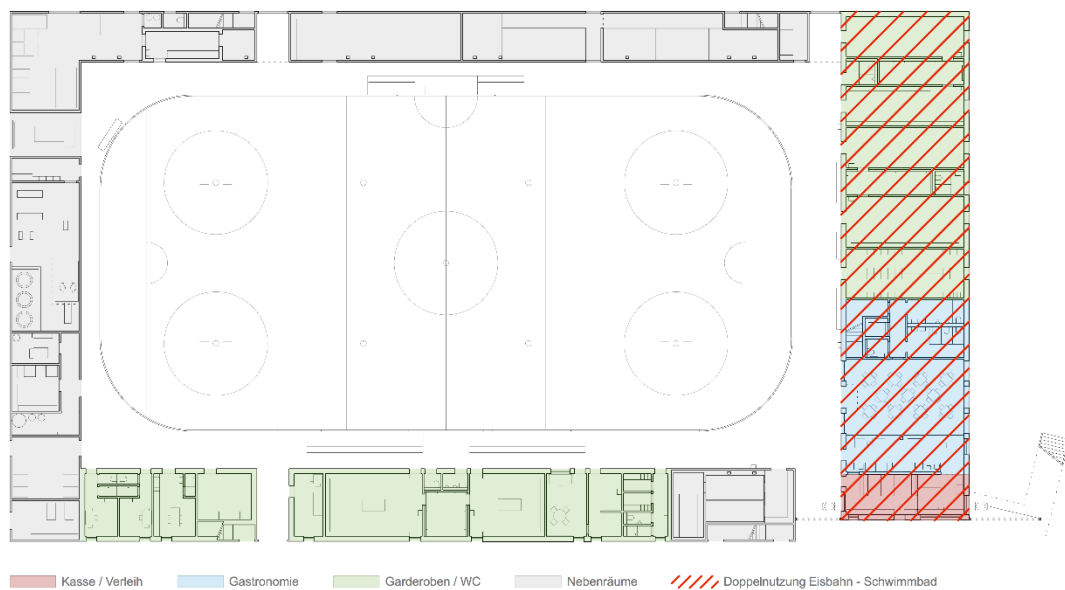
Schema Grundrissorganisation der Eishalle
